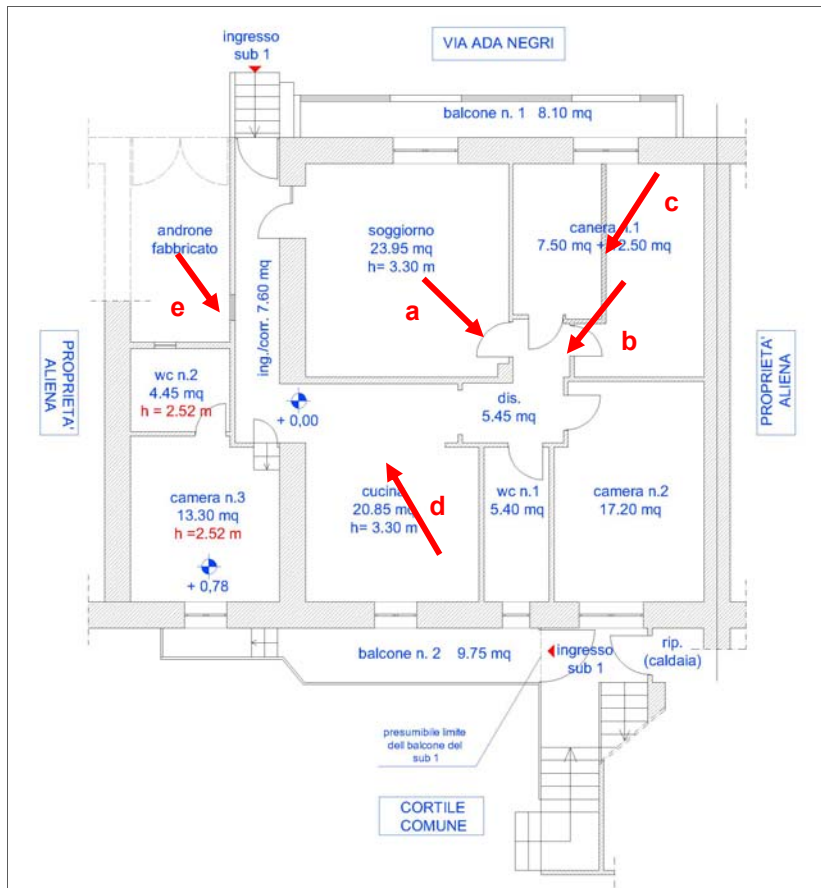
Plan. stato dei luoghi del 13/12/2023
